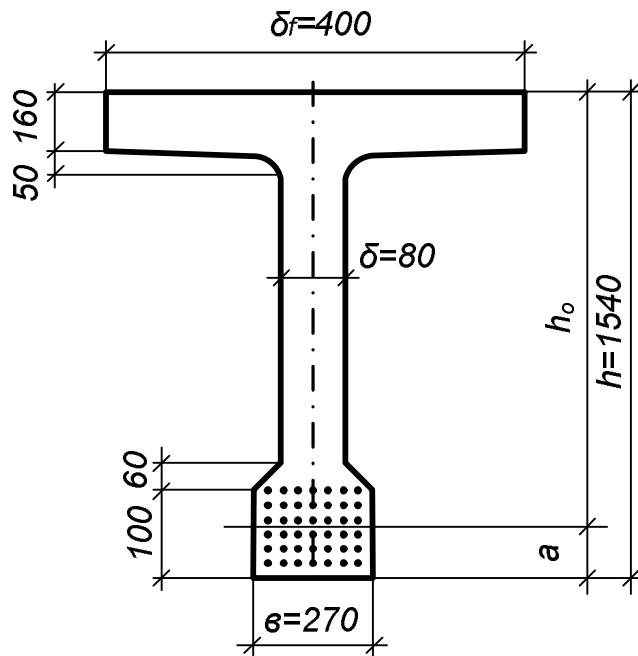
Поперечний переріз балки покриття у середині прольоту
